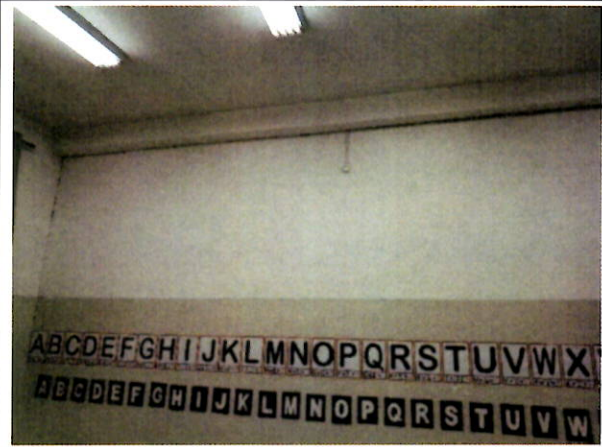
Fissuras observadas em sala de aula situada noo segundo pavimento.
